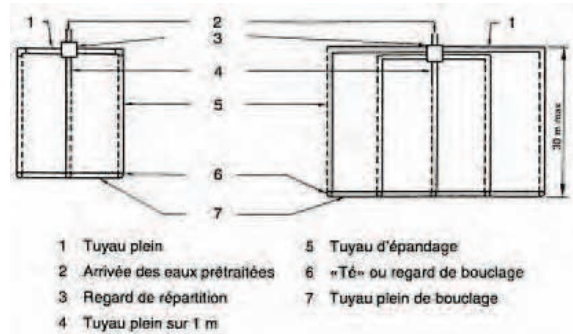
Vues en plan ; exemples à 3 et 5 tranchées
